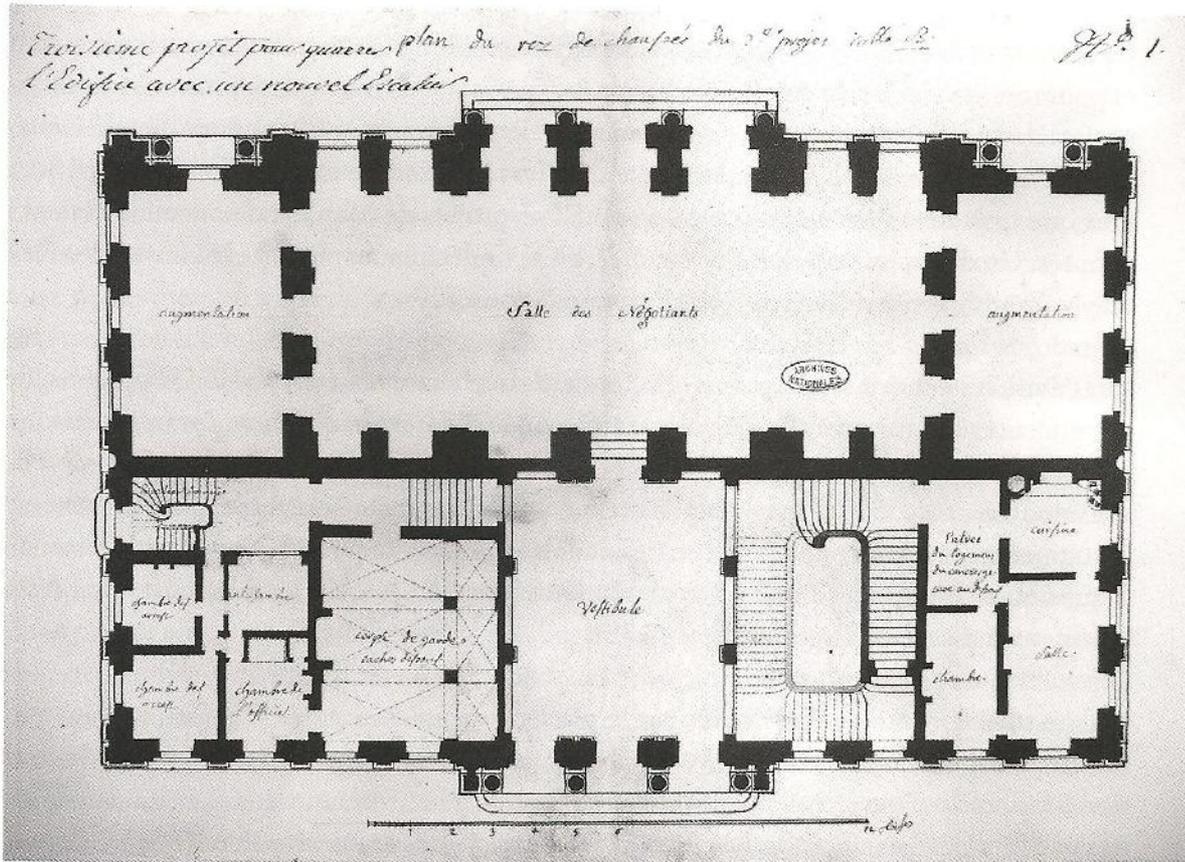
> Mansart de Sagonne : variante au rez-de-chaussée du troisième projet avec escalier latéral, 1748 [© AN, Cartes et plans].
